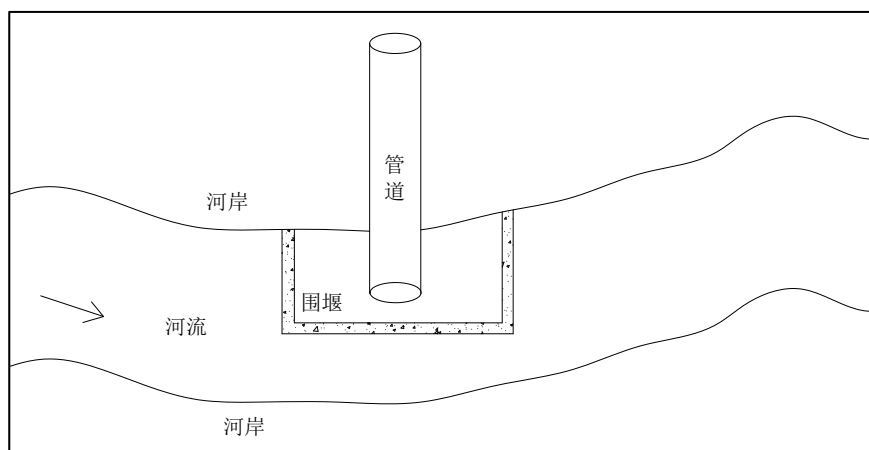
围堰导流穿越河流施工断面示意图
